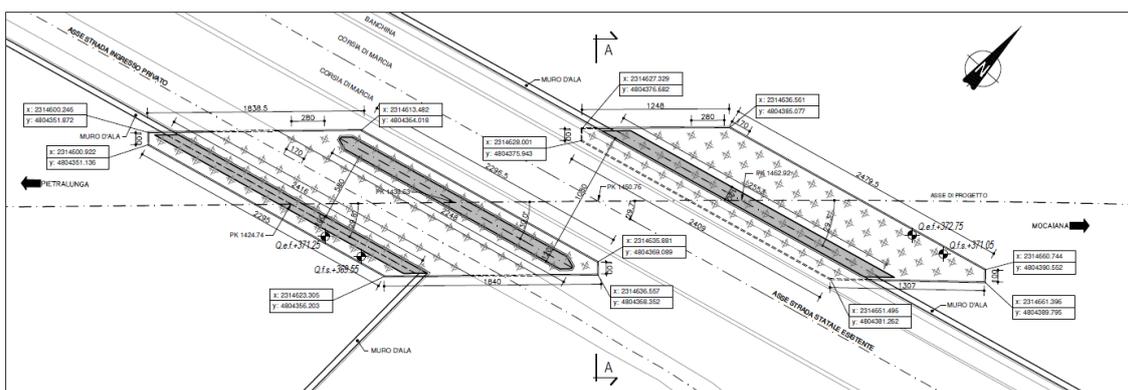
PLANIMETRIA SOTTOPASSO PK 1+450.74
